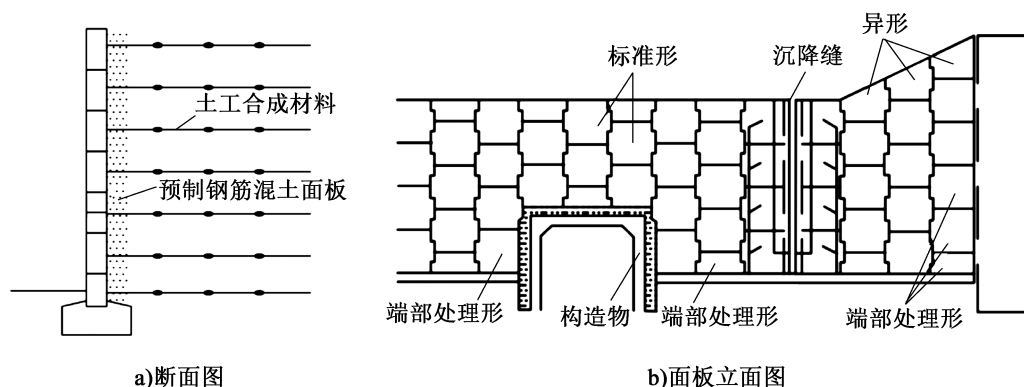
预制钢筋混凝土板块式墙面结构形式示意图
